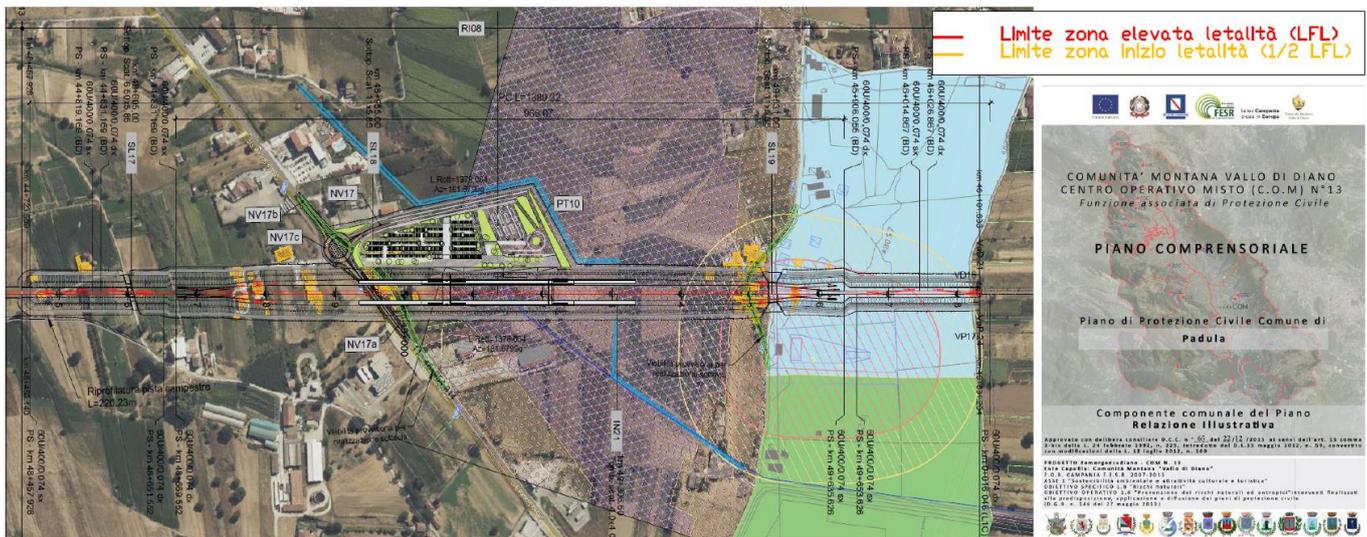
Stralcio planimetrico interferenza soluzione PFTE con zone di rispetto
